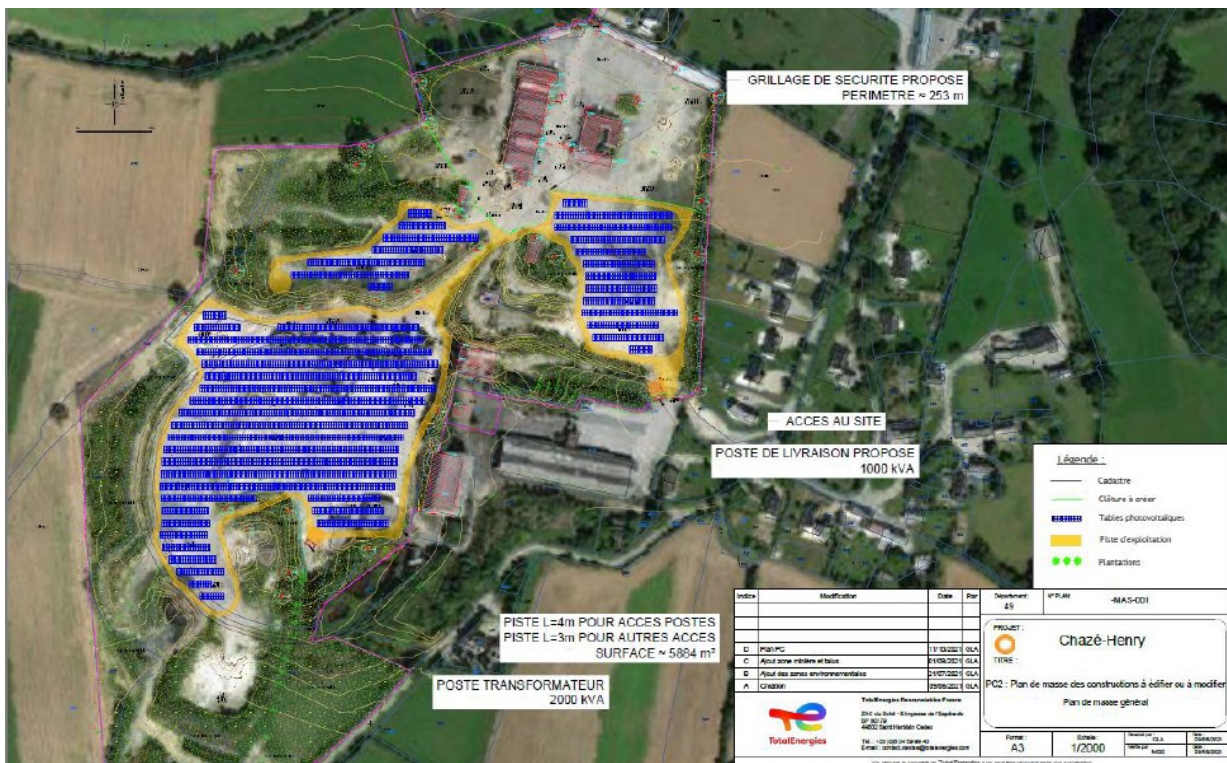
Plan d'implantation de la centrale solaire de Chazé-Henry
